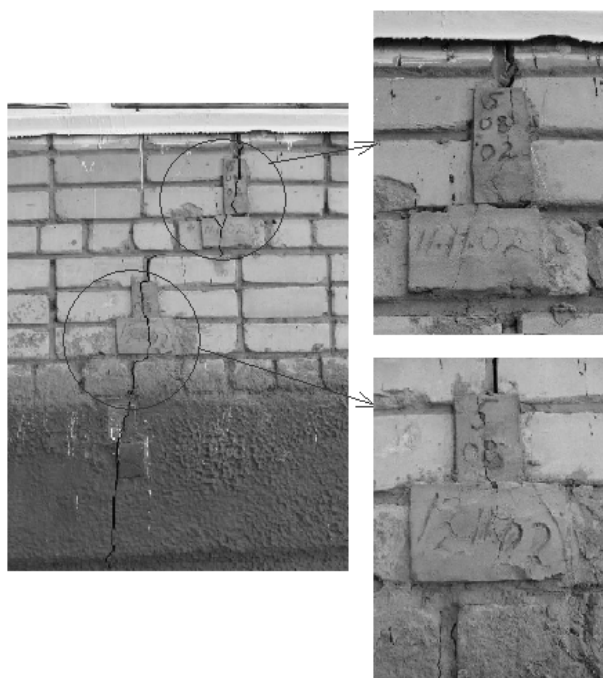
Фасад здания (а), картины трещин в стенах (б)
